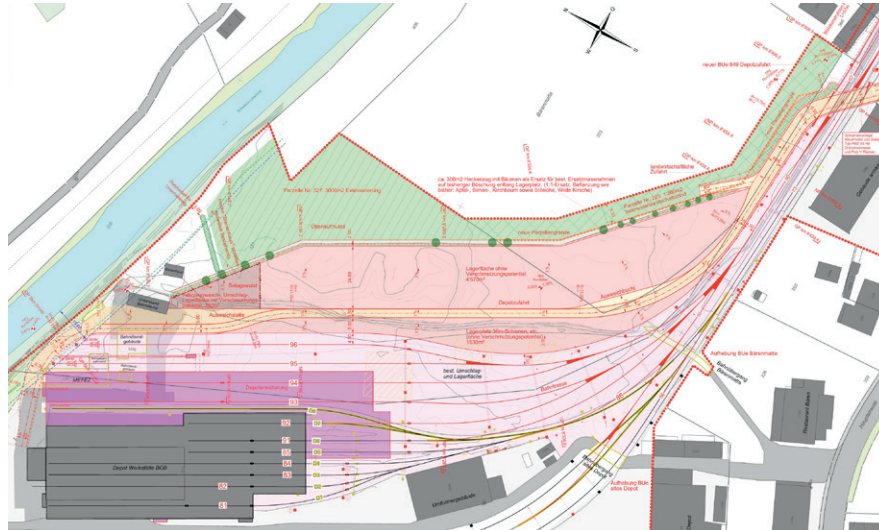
Planausschnitt Auflageprojekt «Erweiterung Depot BOB Zweilütschinen», genehmigt durch das Bundesamt für Verkehr am 30.07.2015
